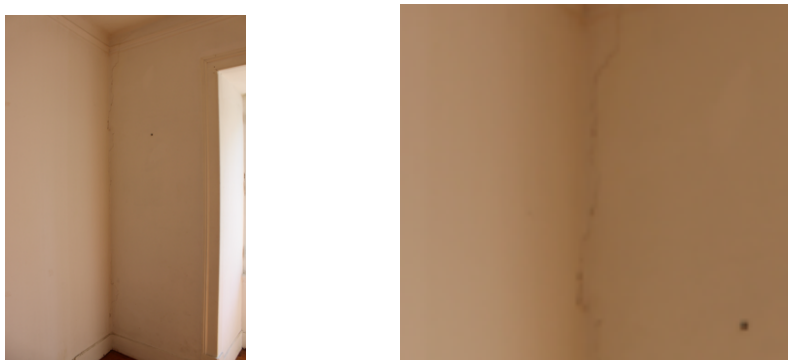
Fissuração nas paredes externas - 5º Andar direito.
